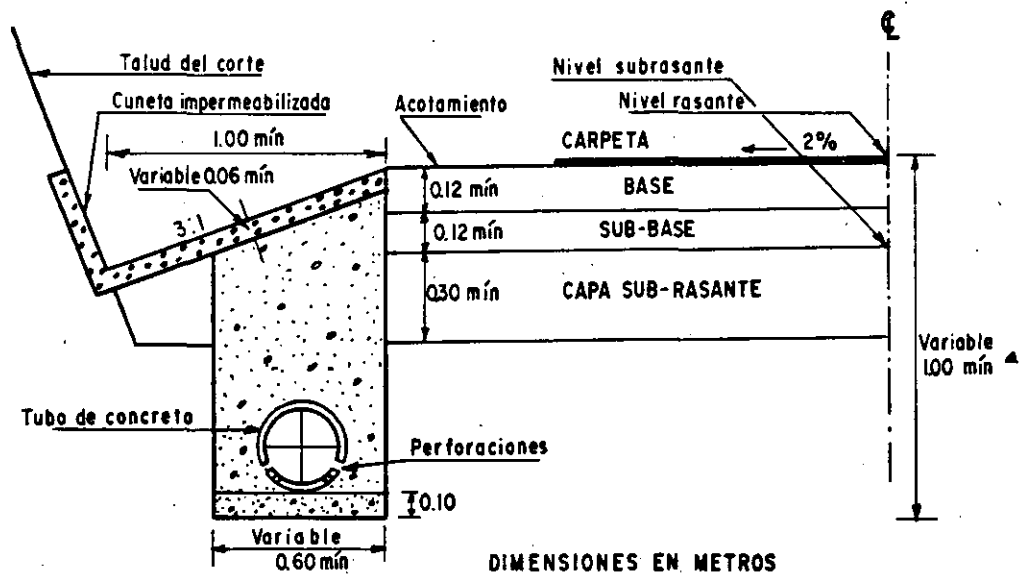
Sección transversal de un subdren longitudinal de zanja, según la práctica mexicana. (Secretaría de Obras Públicas.)
